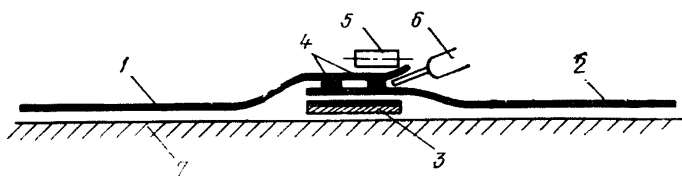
Сварка пленочных полотнищ на месте укладки
